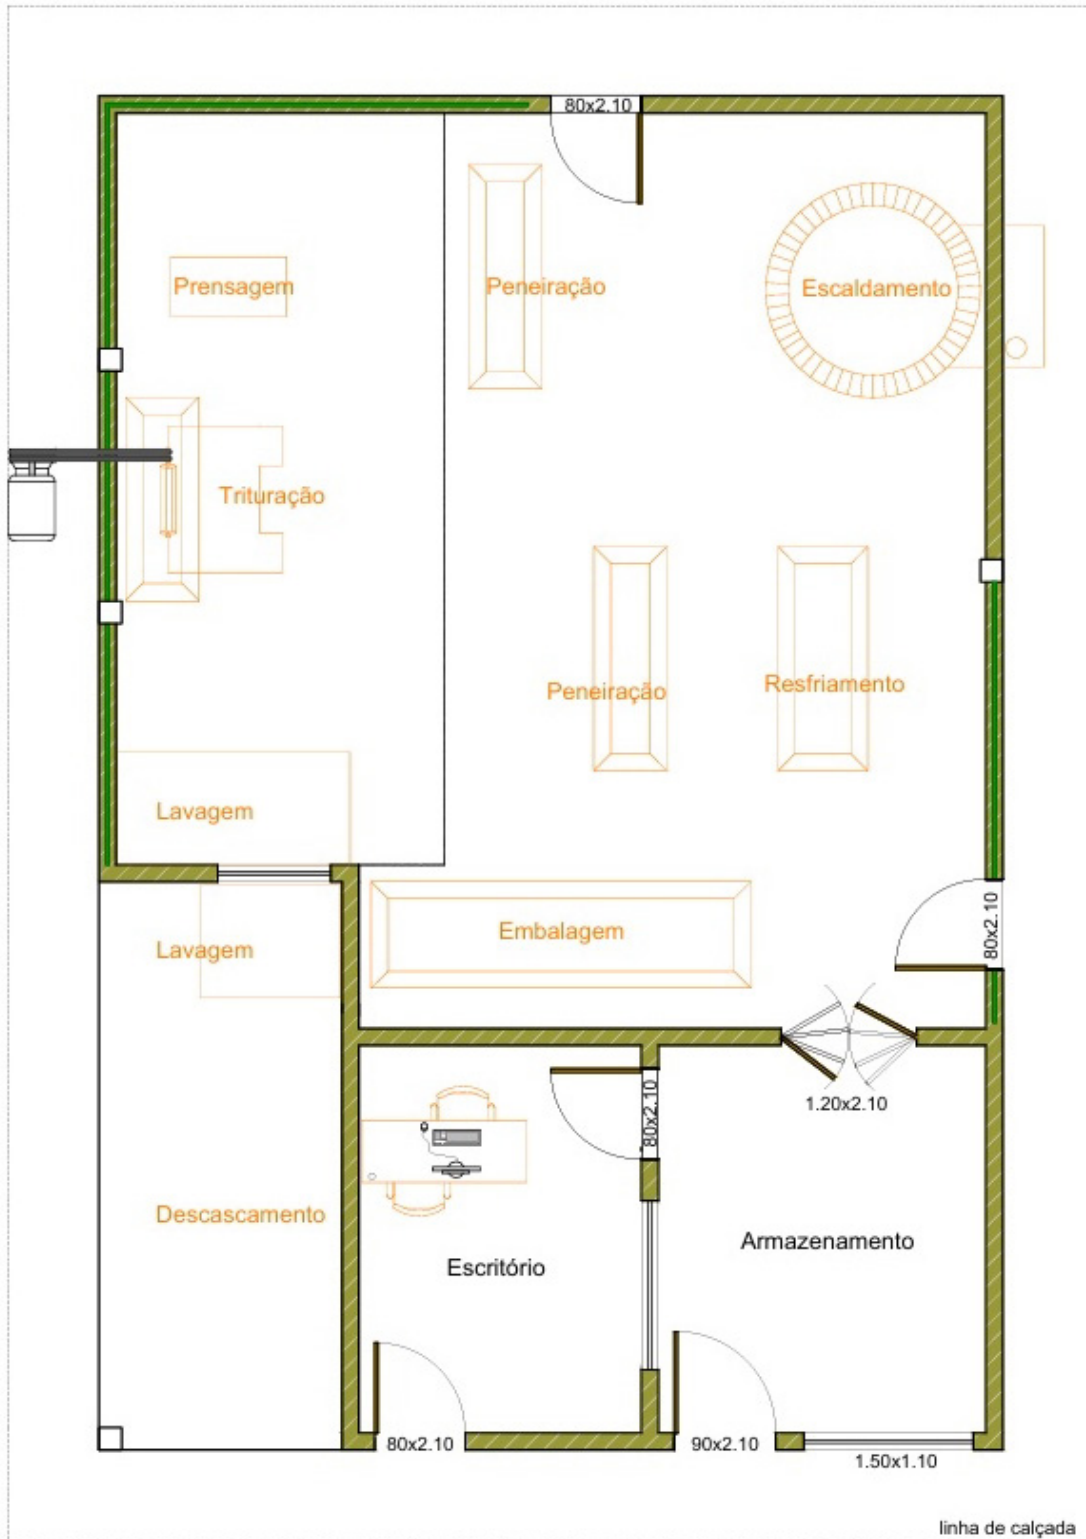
Planta baixa da casa de farinha – escala 1:50.
